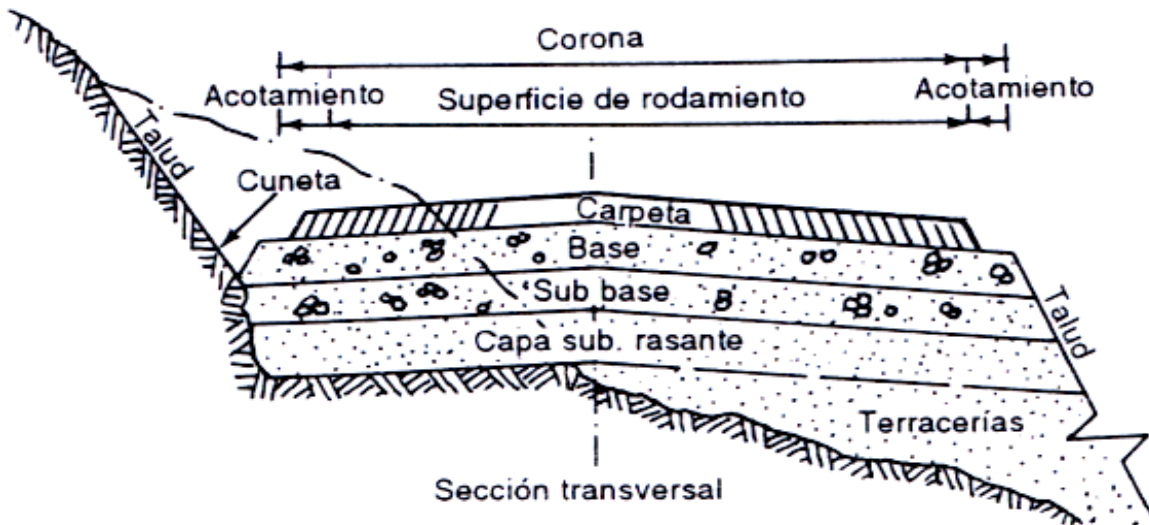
sección transversal típica de un pavimento flexible en una sección en balcón.
